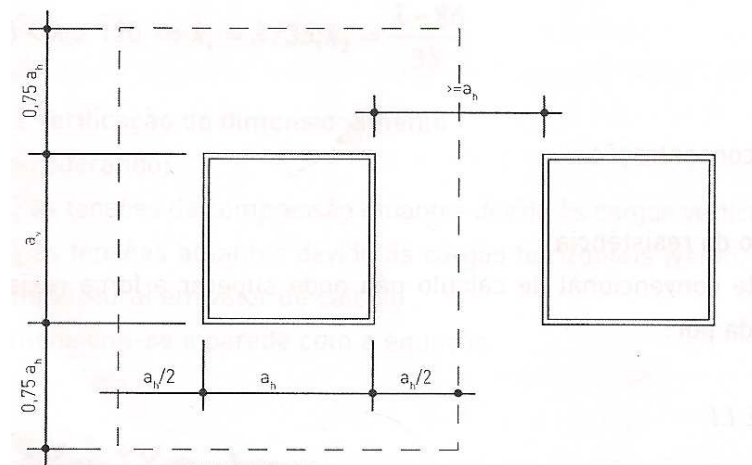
distribuição horizontal de aberturas em uma parede em concreto (ASSOCIAÇÃO BRASILEIRA DE CIMENTO PORTLAND, 2008, p. 48)
